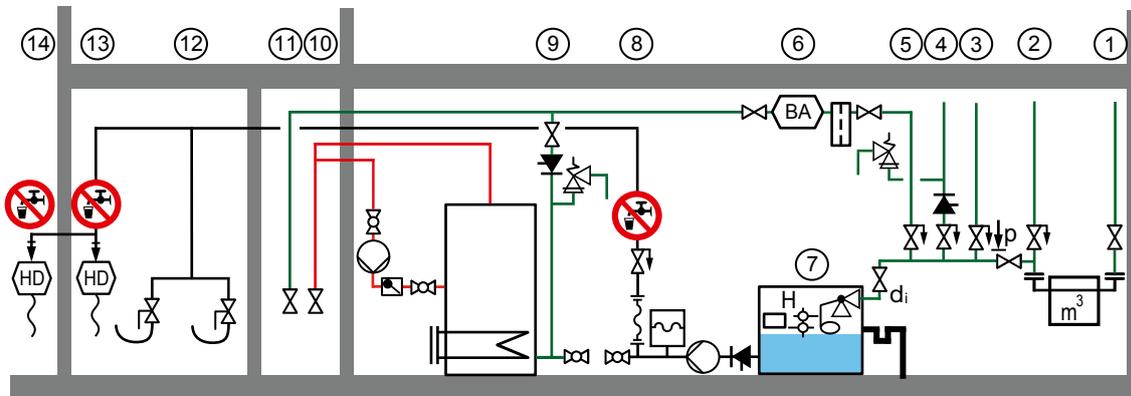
Anschluss eines Betriebes an die öffentliche Wasserversorgung
